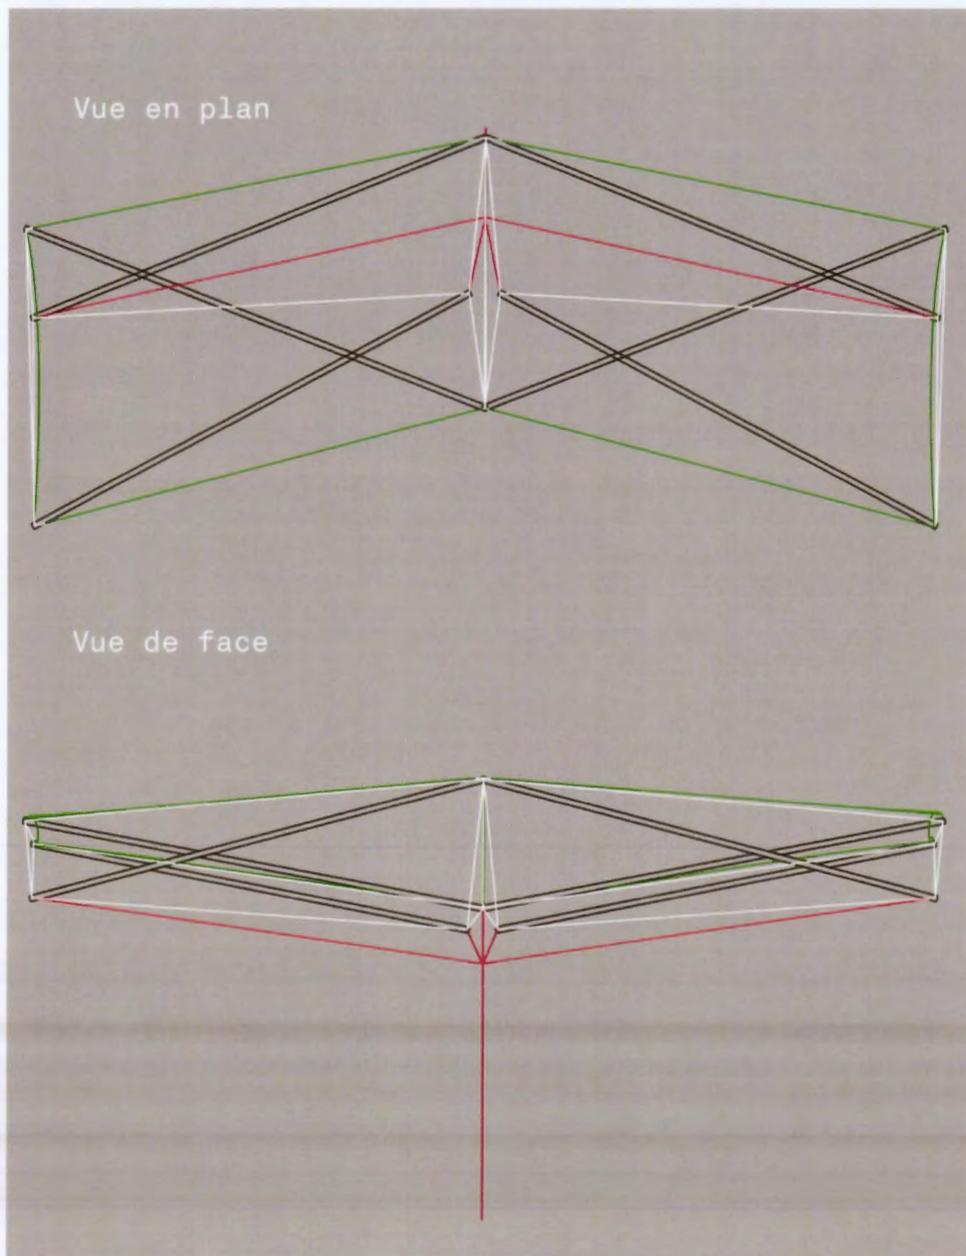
Dessins techniques de planches de présentation : vue en plan, vue de face.
